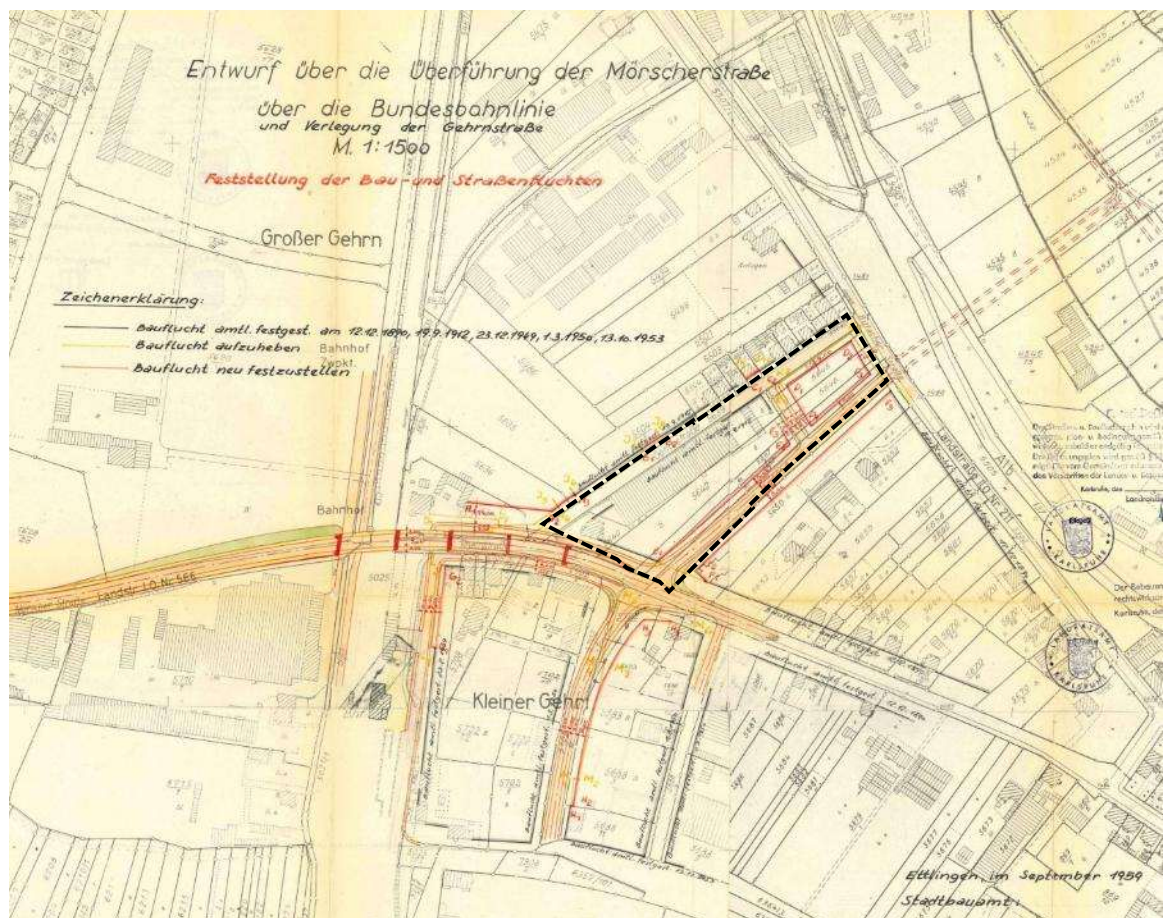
Bebauungsplan „Überführung der Mörscherstraße über die Bundesbahnlinie“, 1962 mit Plangebiet (schwarz)
